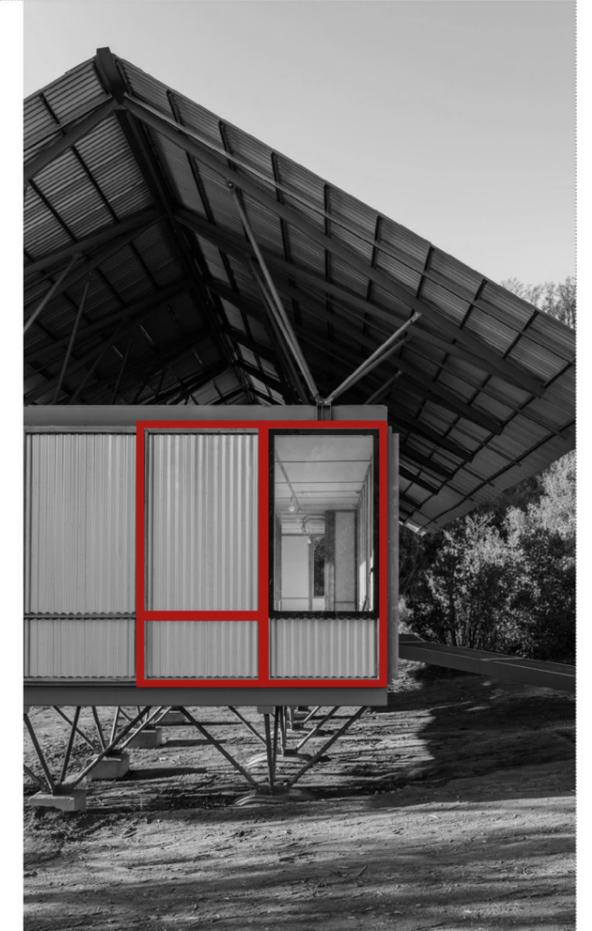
Modulación de paneles de envolventes verticales de la obra. Fuente: (Revista arquitectura viva, s. f.)
